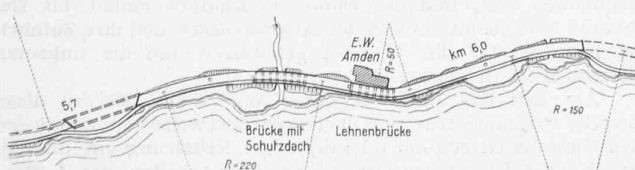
Lageplan beim Elektrizitätswerk Amden.
